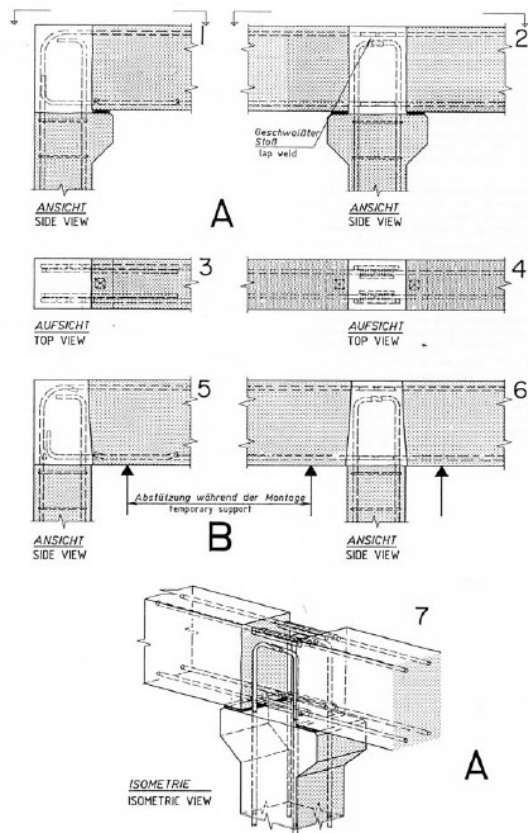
Ligação por betonagem *in situ* do nó (Stupré, 1981)
